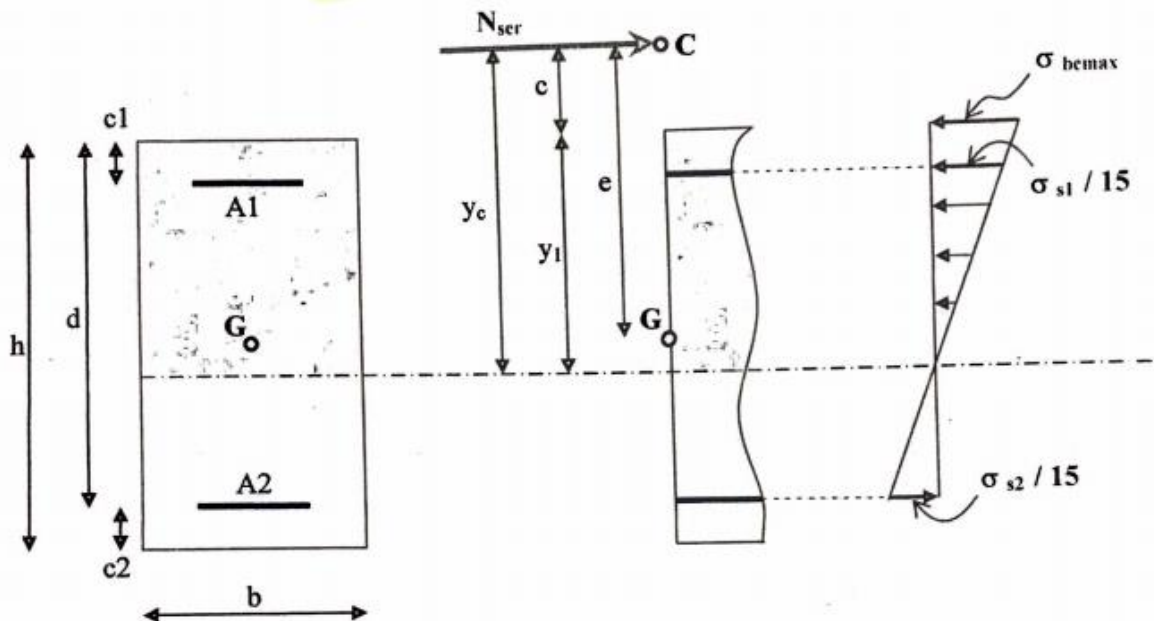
Coupe transversale d'une section de poutre partiellement comprimée.
